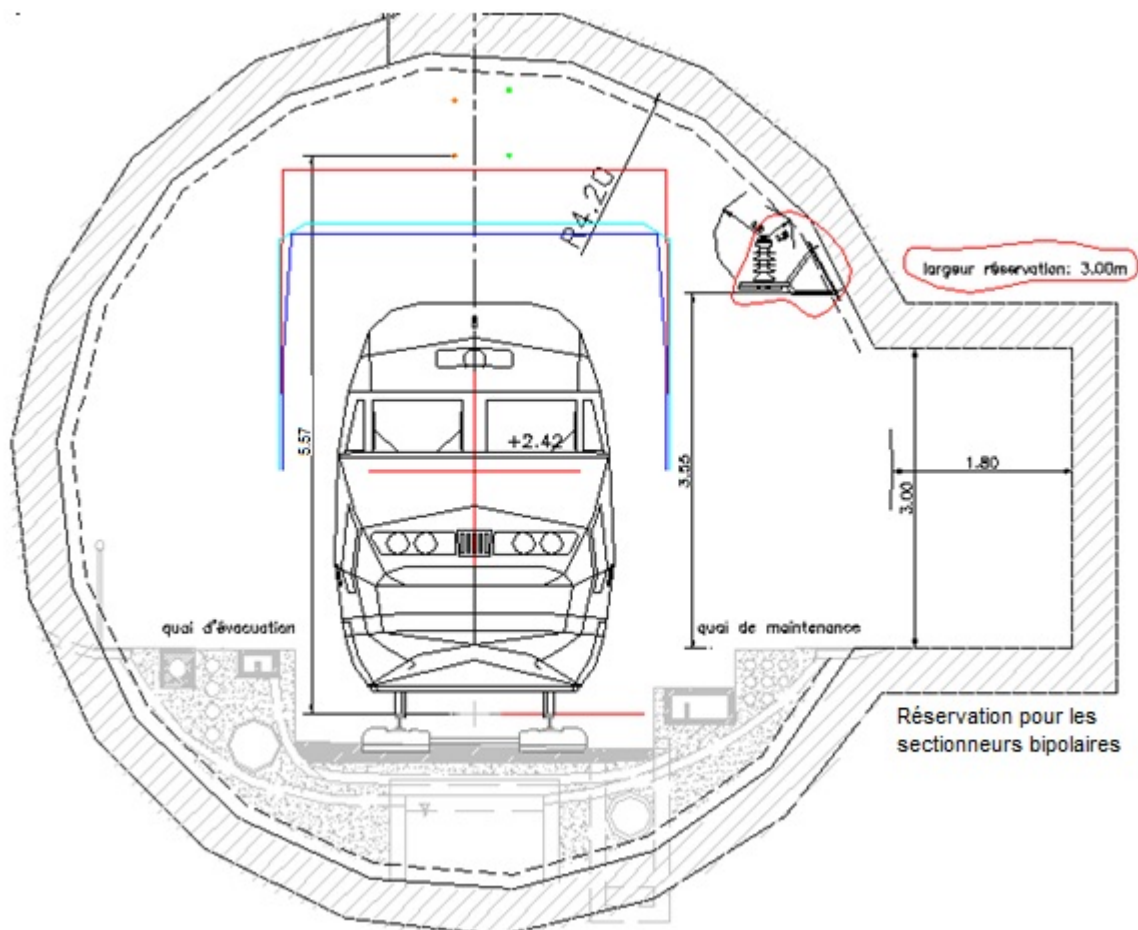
Coupe type de la réservation faite dans les tunnels pour l'emplacement des appareils de coupure
